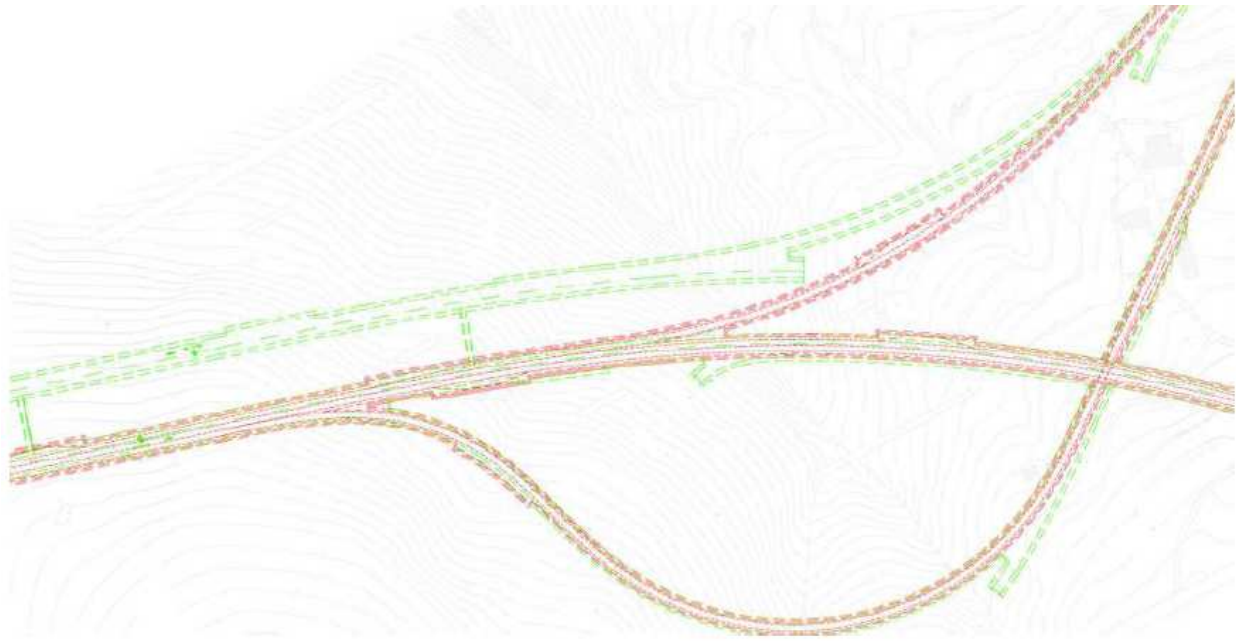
Codolazza – Sovrapposizione tra planimetria di PE 2006 (verde) e Perizia variante 2020
